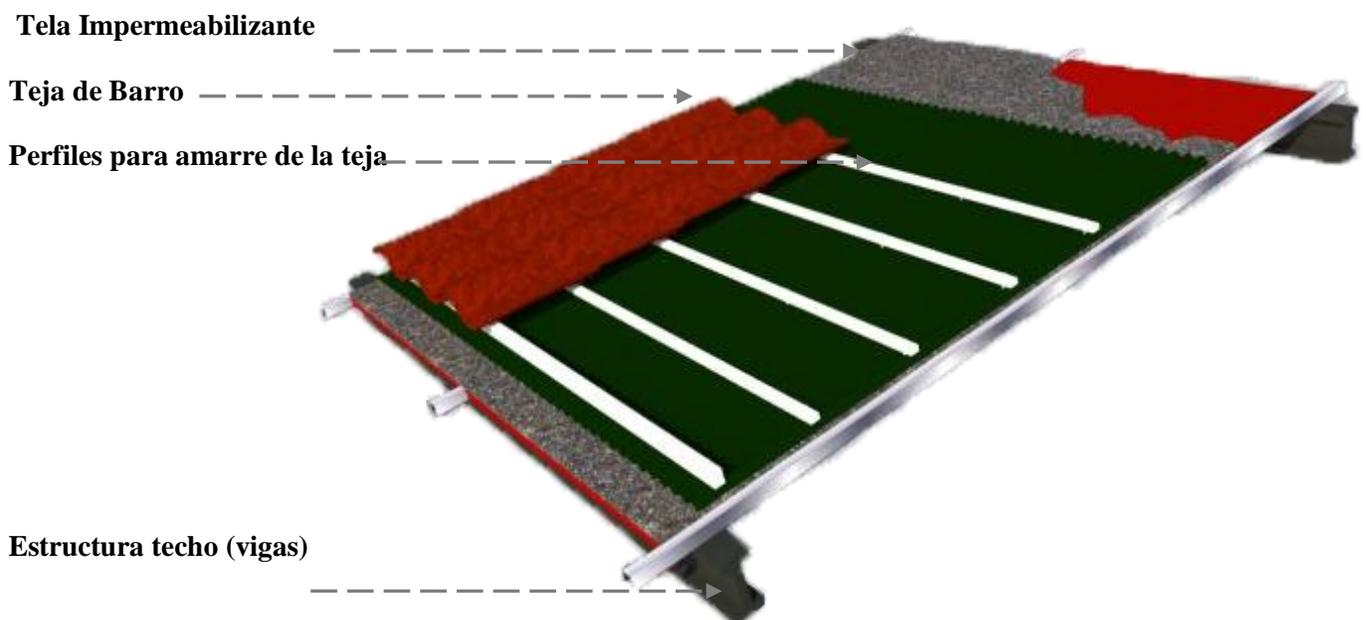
Detalle constructivo cubierta con teja de barro-Sebastian Monroy-2014 Detalle Cubierta
